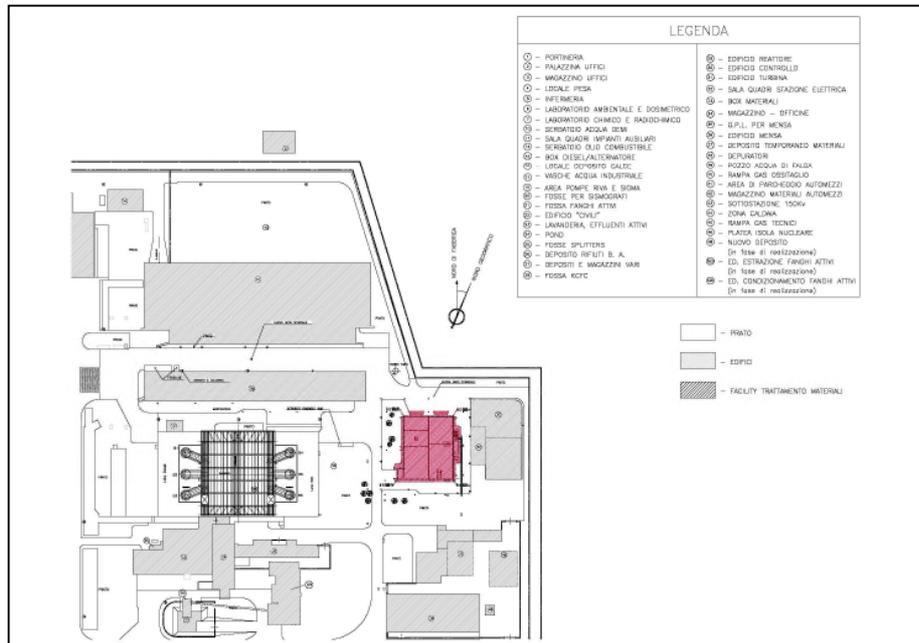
Ubicazione dell'Edificio della Facility all'interno dell'impianto.
